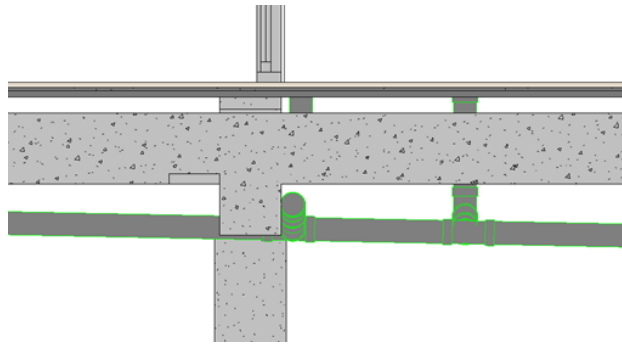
Instalación de saneamiento en planta garaje, sección modelado en BIM.
